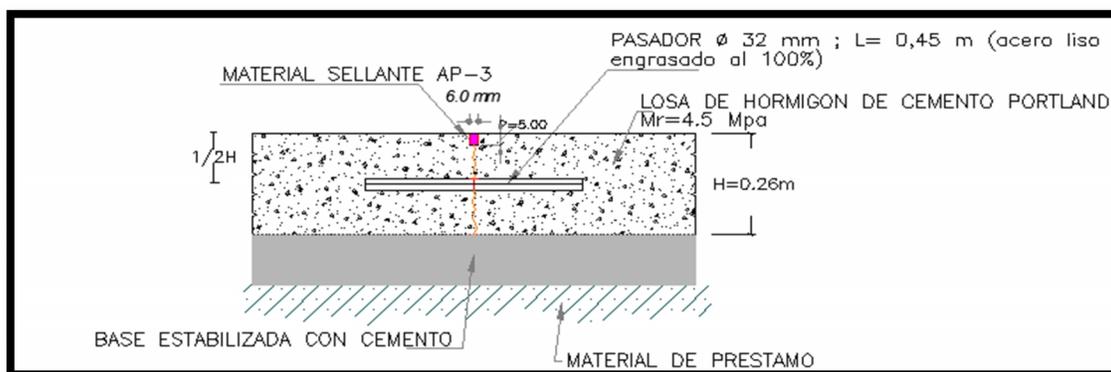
Detalle del pasador de las juntas longitudinales de construcción
